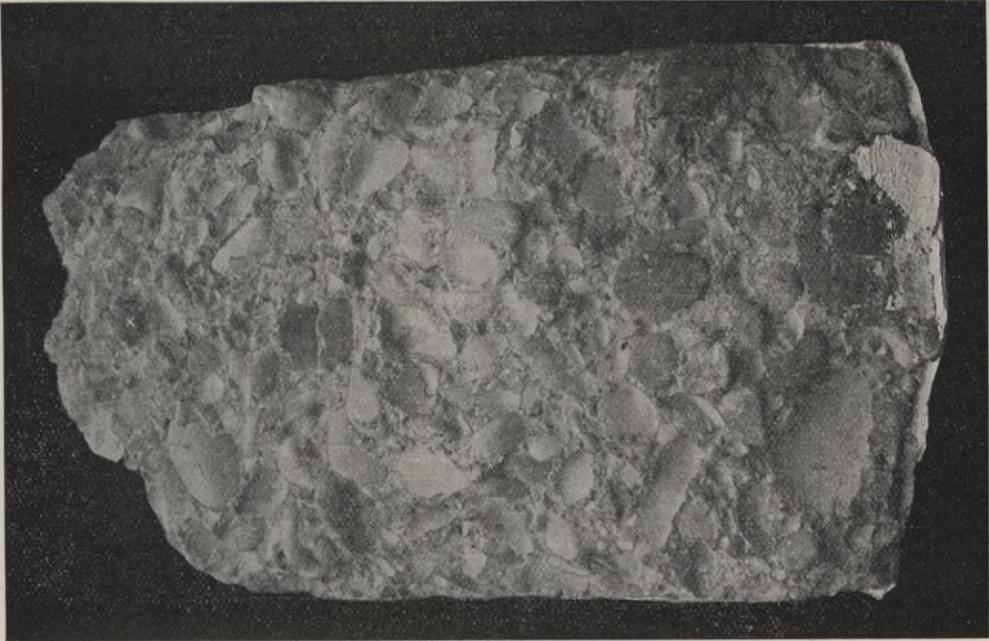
Bruchfläche einer Druckprobe aus Kiesbeton.
